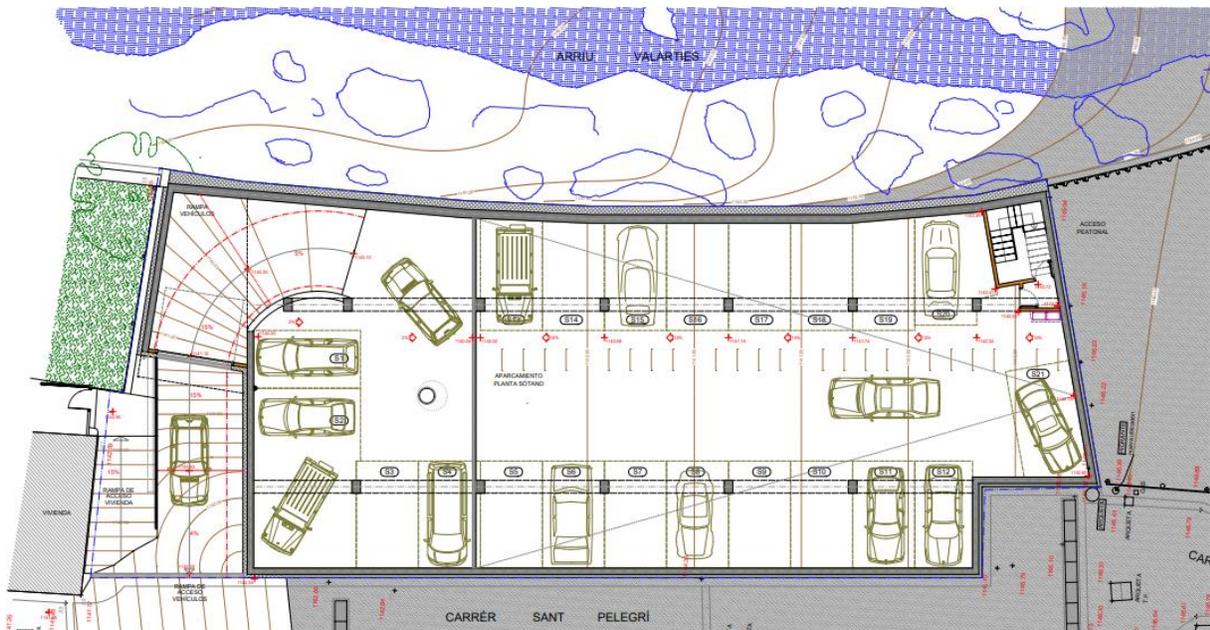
Planta del caso de uso utilizado como modelo para el ejemplo de implementación. Fuente: planos del proyecto
